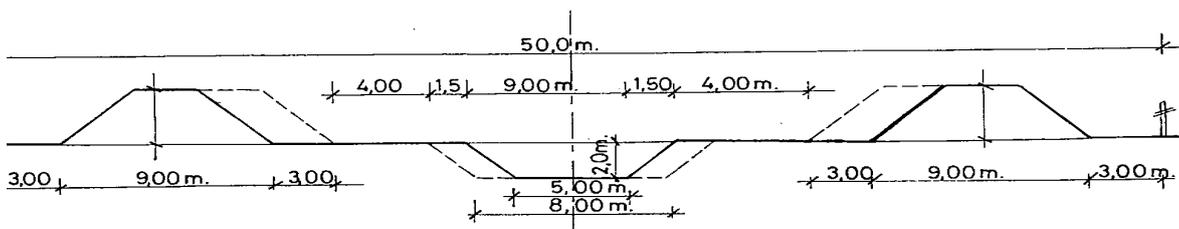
Perfil tipo canal Interlagos. Tramo A. Golondrinas- Ruta Prov N° 13
